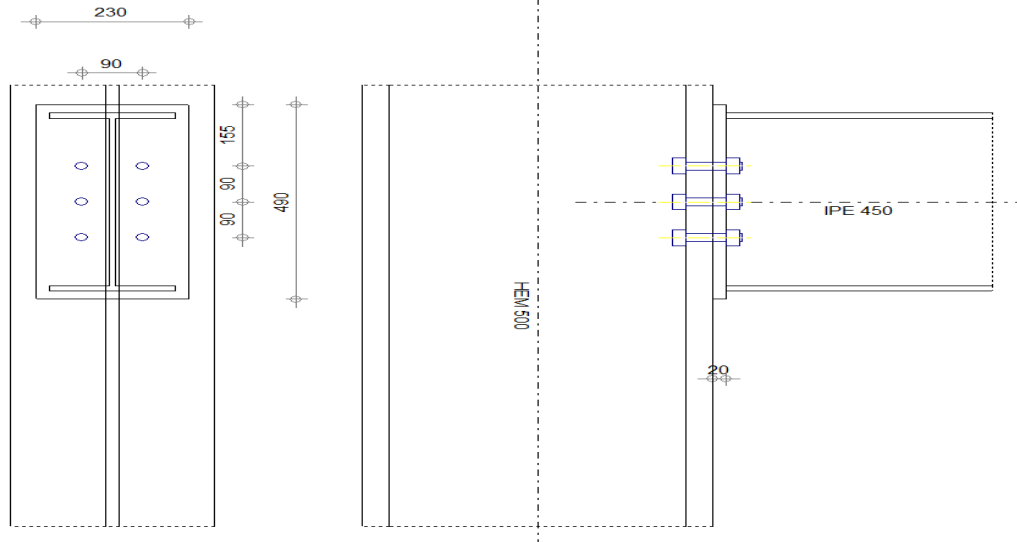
Détails assemblage Poteau HEM500 poutre IPE450
